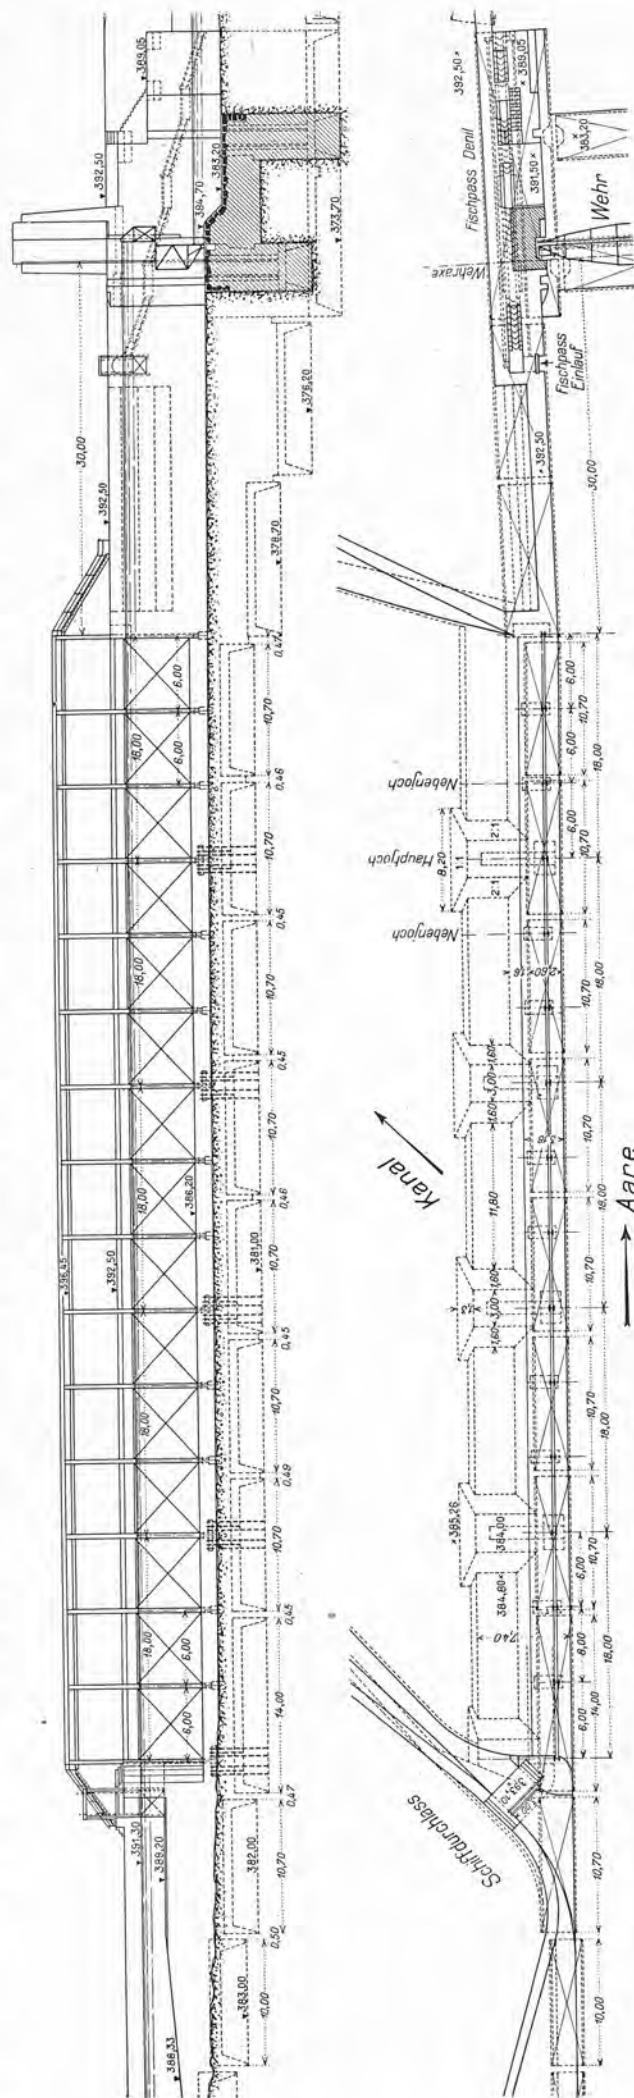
und 39. Grundriss und Aufriss des Kanal-Einlaufbauwerks; rechts Schnitt durch Oeffnung 5 („Grundablass“) des Stauwehres (vergl. Abb. 8 und 9 auf Seite 6). — Masstab 1:600.
